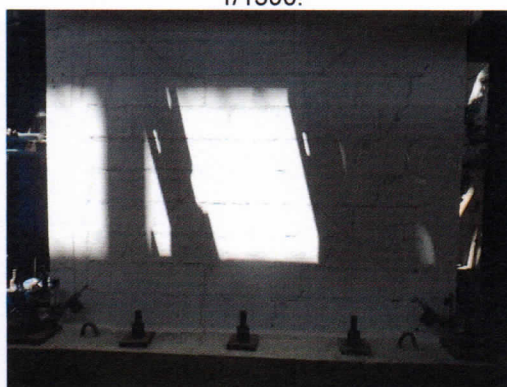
Formación de grietas diagonales en el mortero y primera grieta en ladrillo en la parte superior Este y Oeste de la cara Norte para una distorsión 1/1500.
